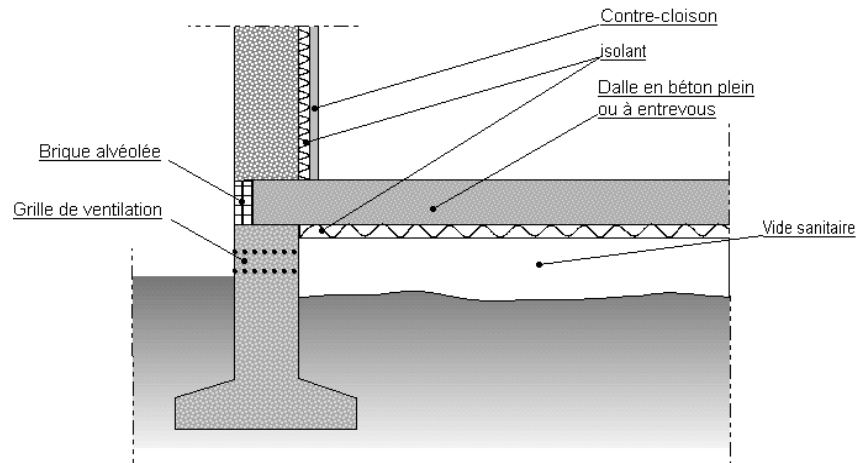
Dalle sur vide sanitaire [Collignan and Sullerot, 2008].
